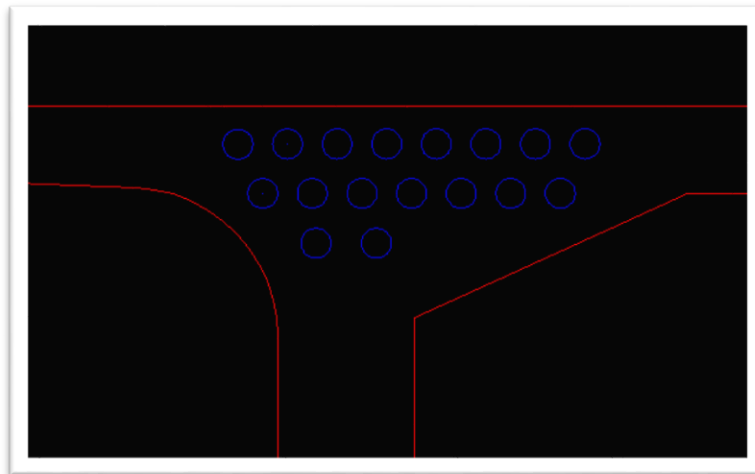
Dispositions des câbles au niveau du voussoir sur pile
